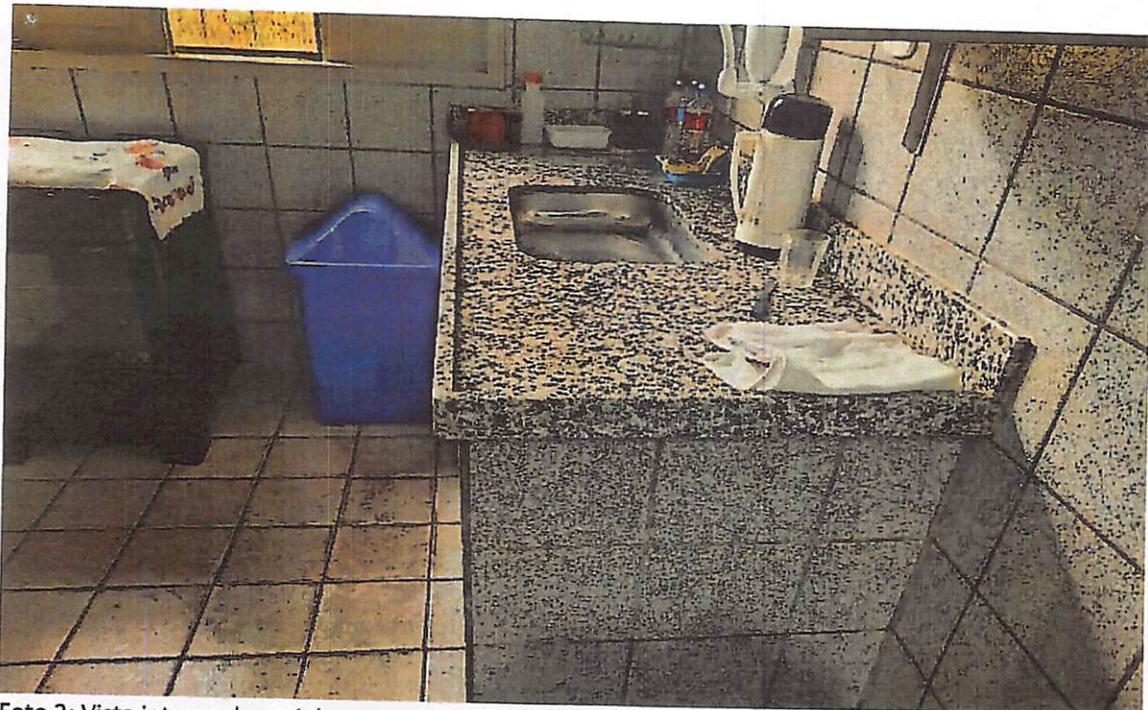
Vista interna da cozinha com piso cerâmico e azulejo até 1,80 m.
